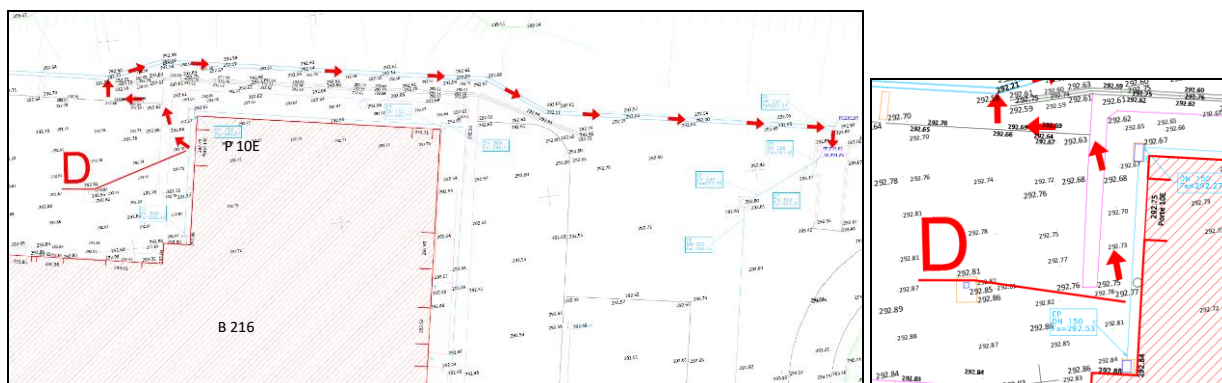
Ecoulement des eaux de ruissellement sur la voirie au droit de la porte 10E
